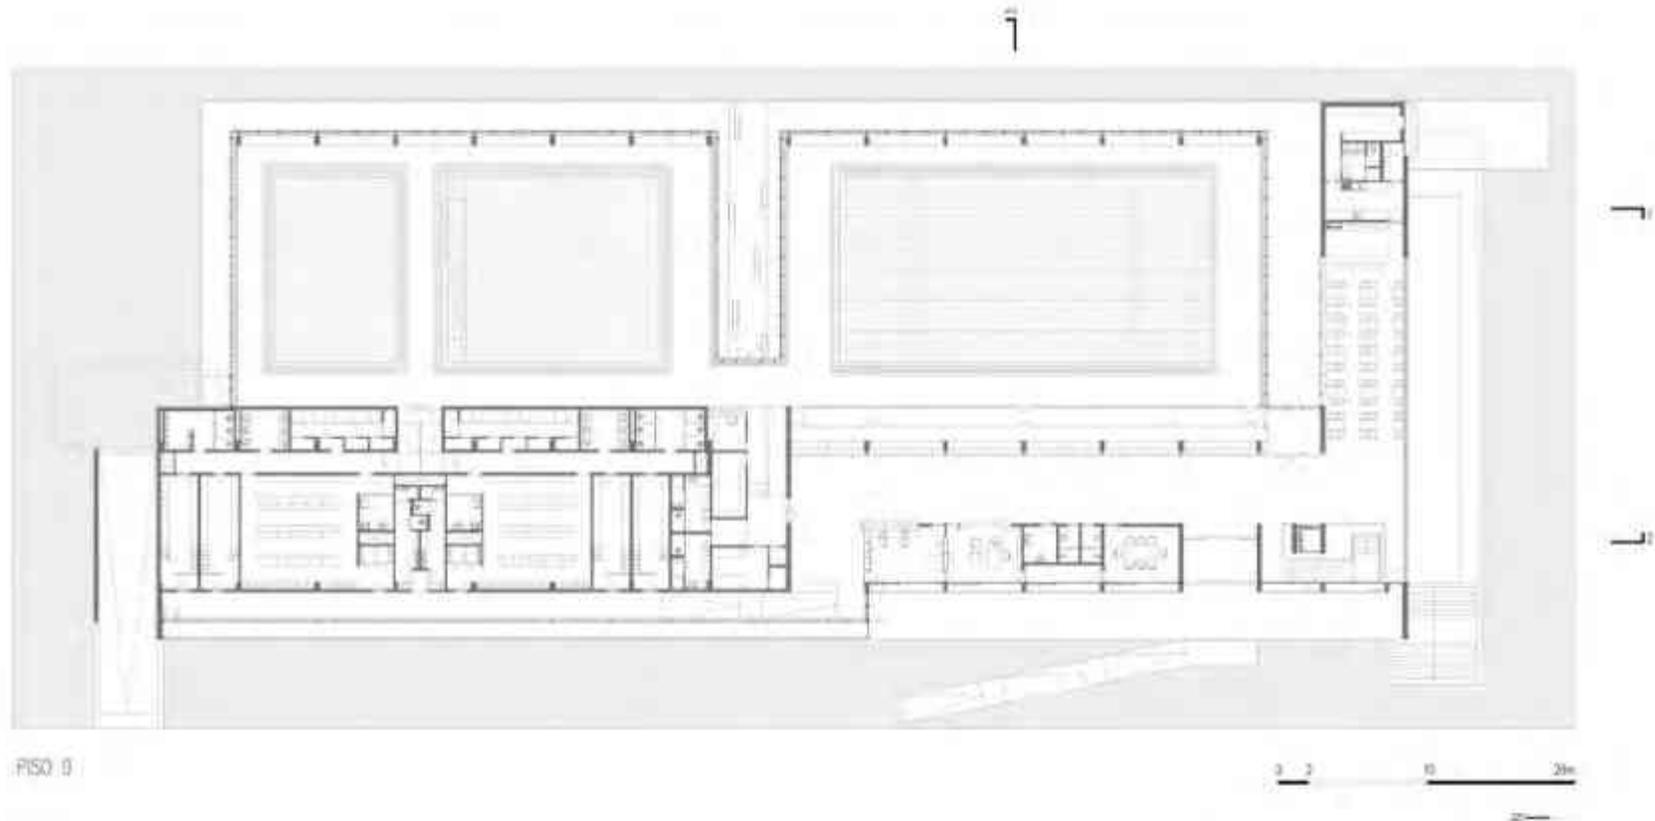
Planta Arquitectónicas de las Piscinas Riberao.
